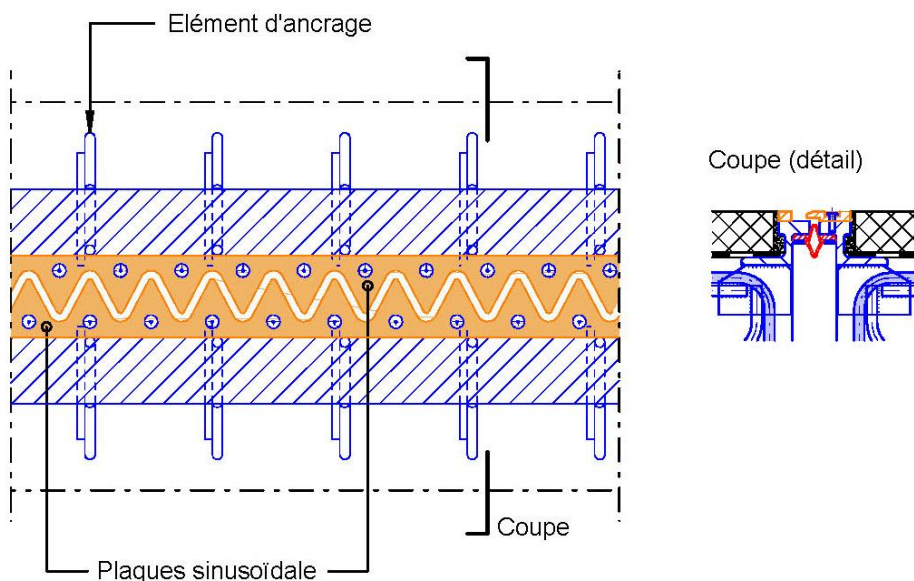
Vue de dessus et coupe schématiques d'un joint de chaussée à profilé compressible et plaque sinusoïdale.
